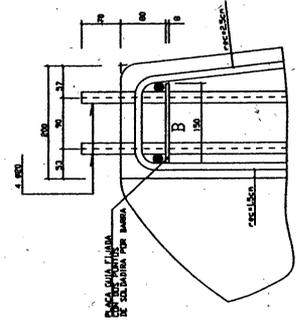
DETAILLE DE BARRERA ("in situ") SECTION 3-3
